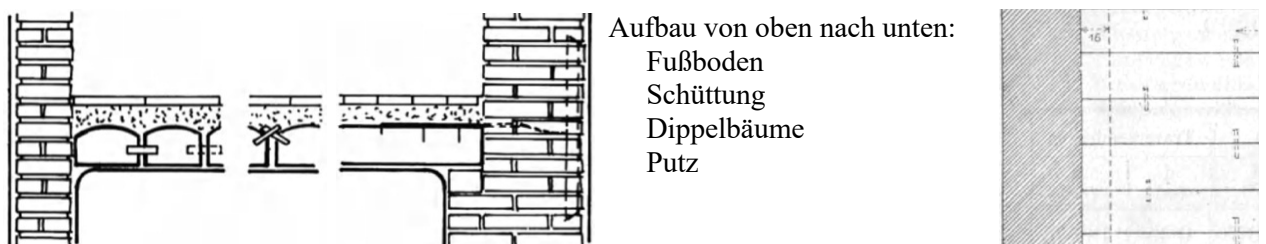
Dippelbaumdecke (links: Querschnitt [15]; mittig Längsschnitt [15]; rechts: Grundriss [30])
